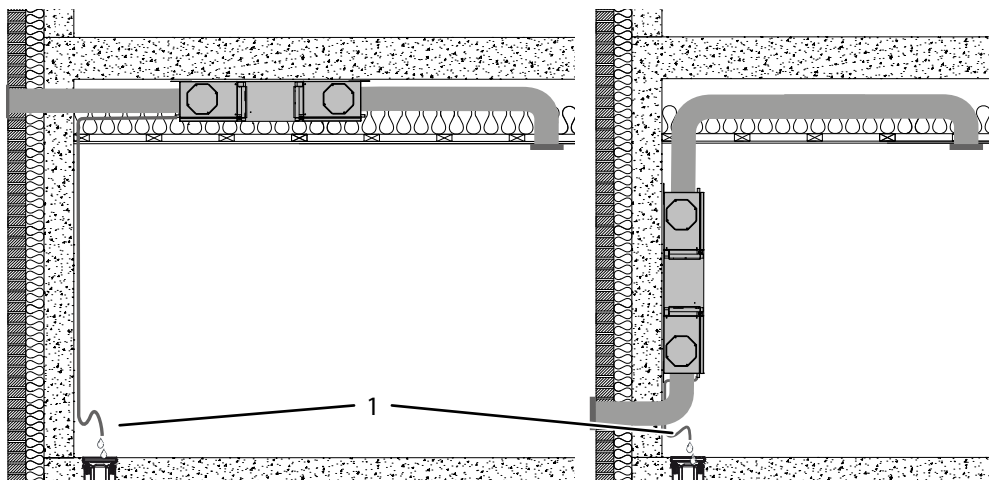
montage au plafond (à gauche) et montage au mur (à droite) avec tuyau d'écoulement de l'eau de condensation
